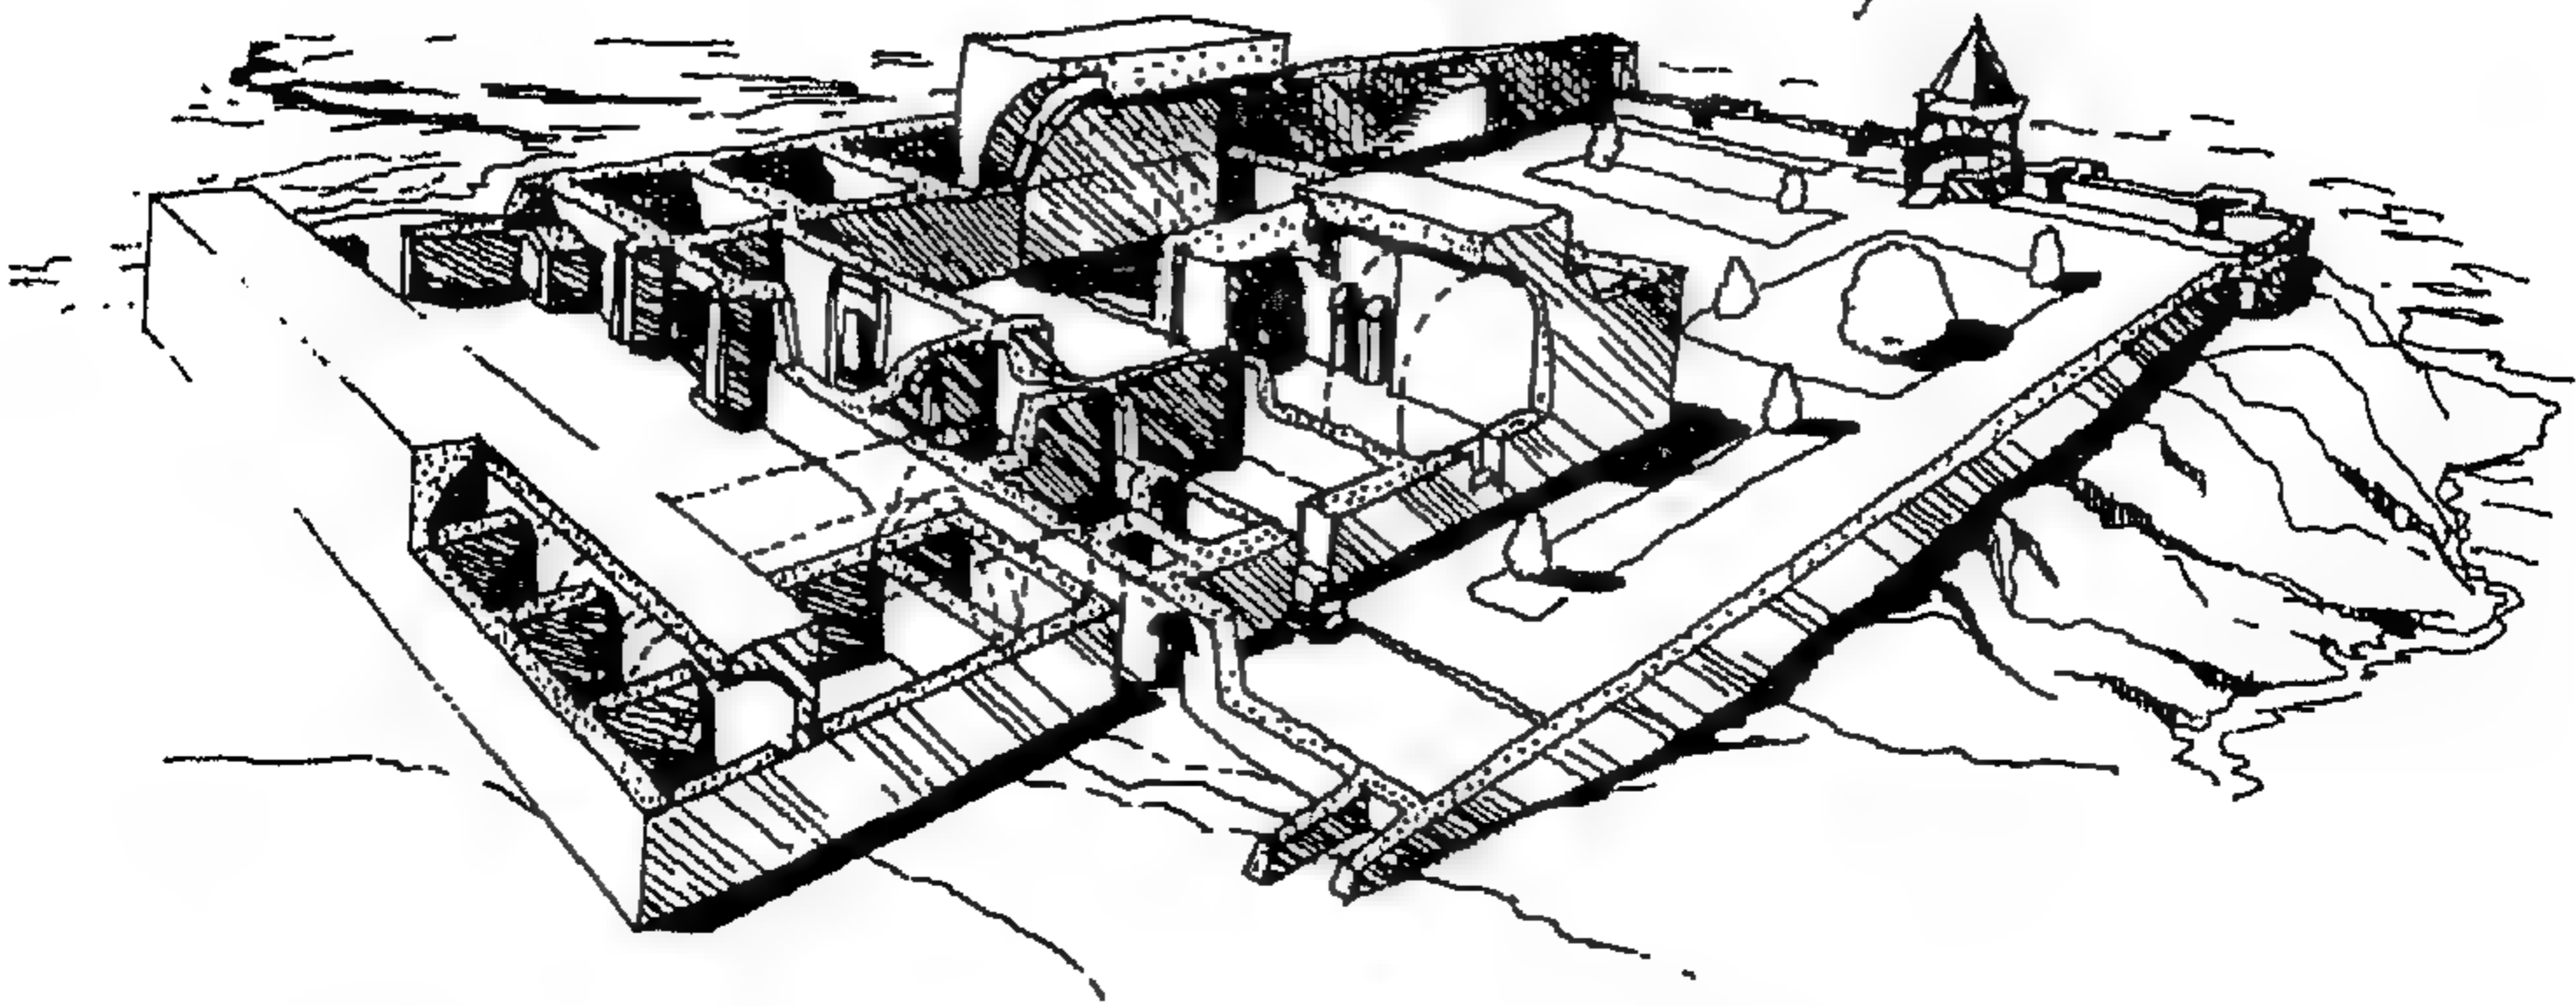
مسقط أفقي لاراستا غازي خسرو بك الملحقة
